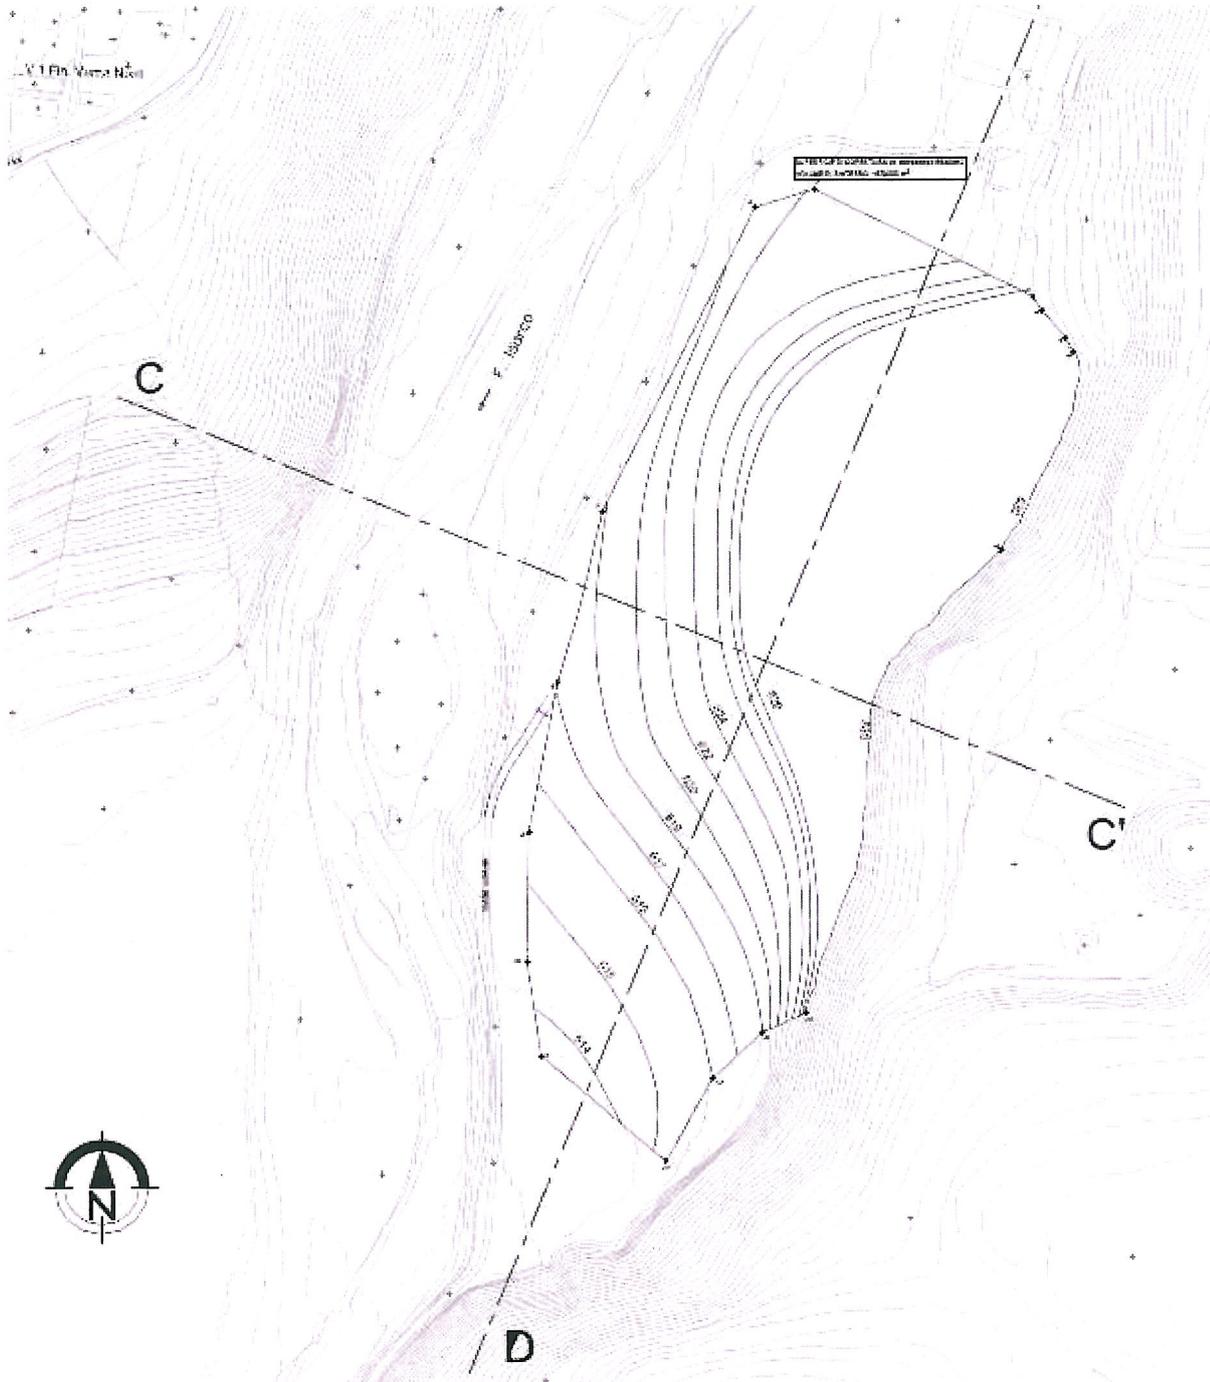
Depositi definitivi in Val Riga – B – Plaikner – Planimetria di progetto
